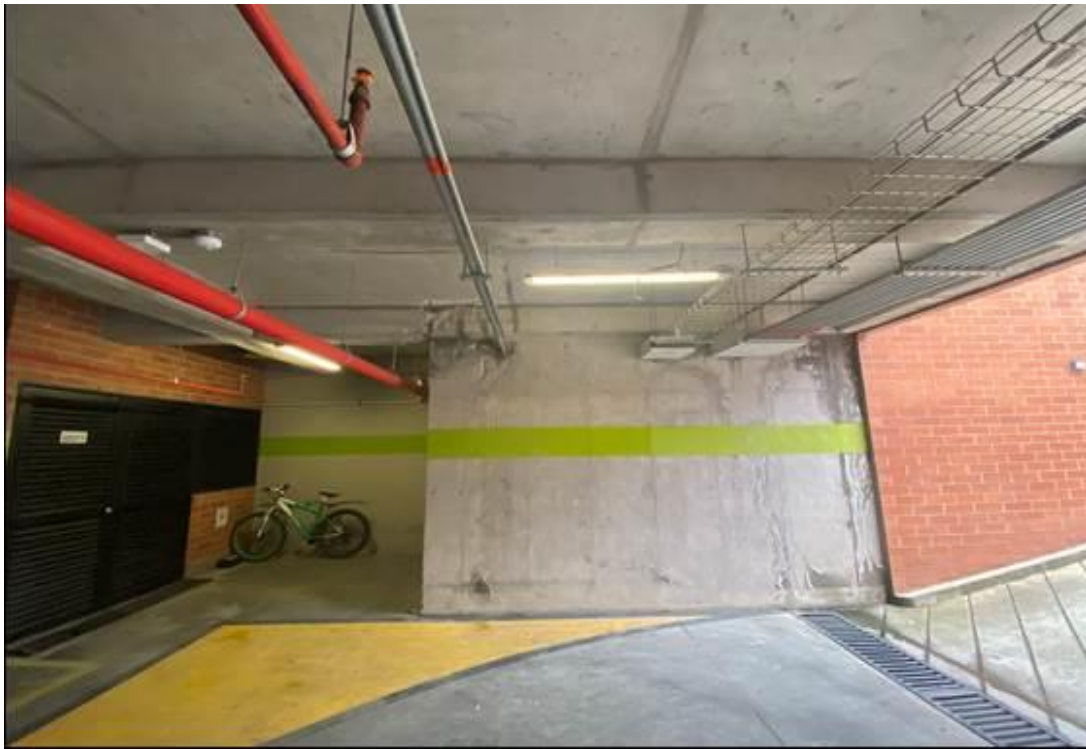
Filtraciones por fisuras muro de contención sótano
